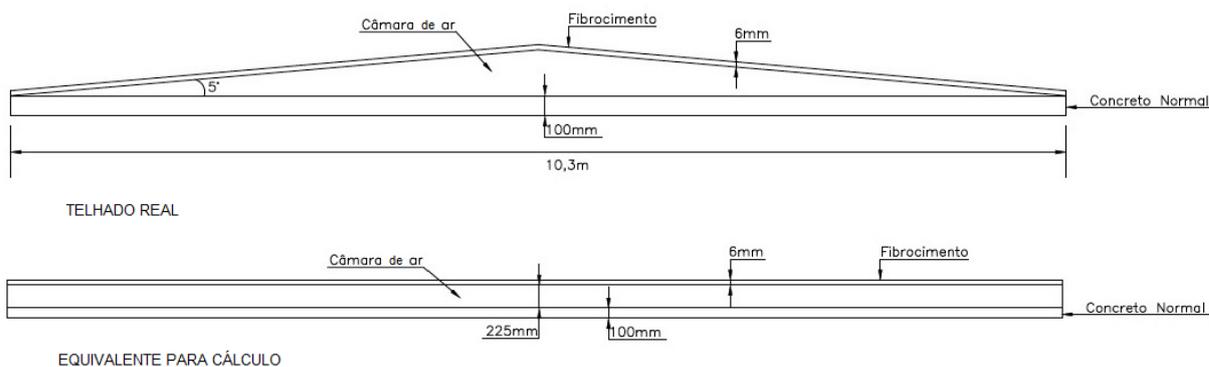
Telhado inclinado de chapas de fibrocimento com laje em concreto normal e câmara de ar não ventilada.
